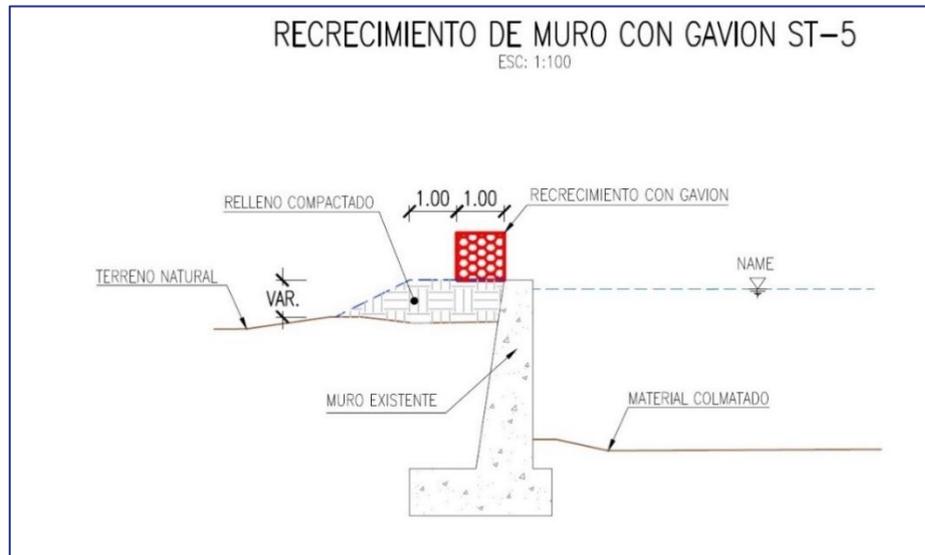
Recrecimiento de muro con gavión ST-5.
